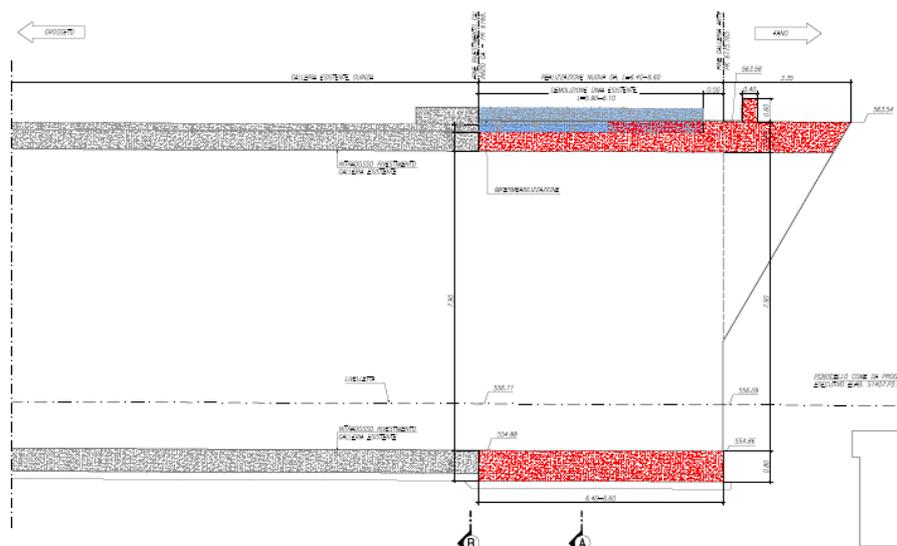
Galleria Guinza - Imbocco lato Marche - Profilo galleria artificiale
